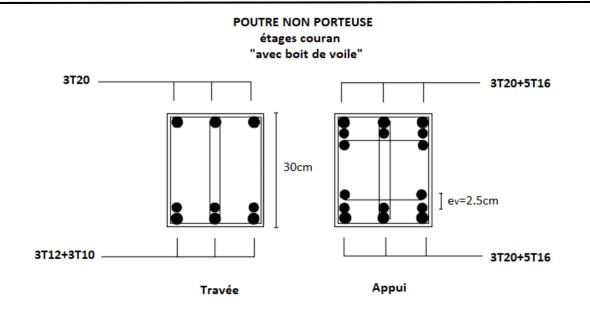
ferraillage des poutres non porteuse Etage Courant avec bout de voile.
